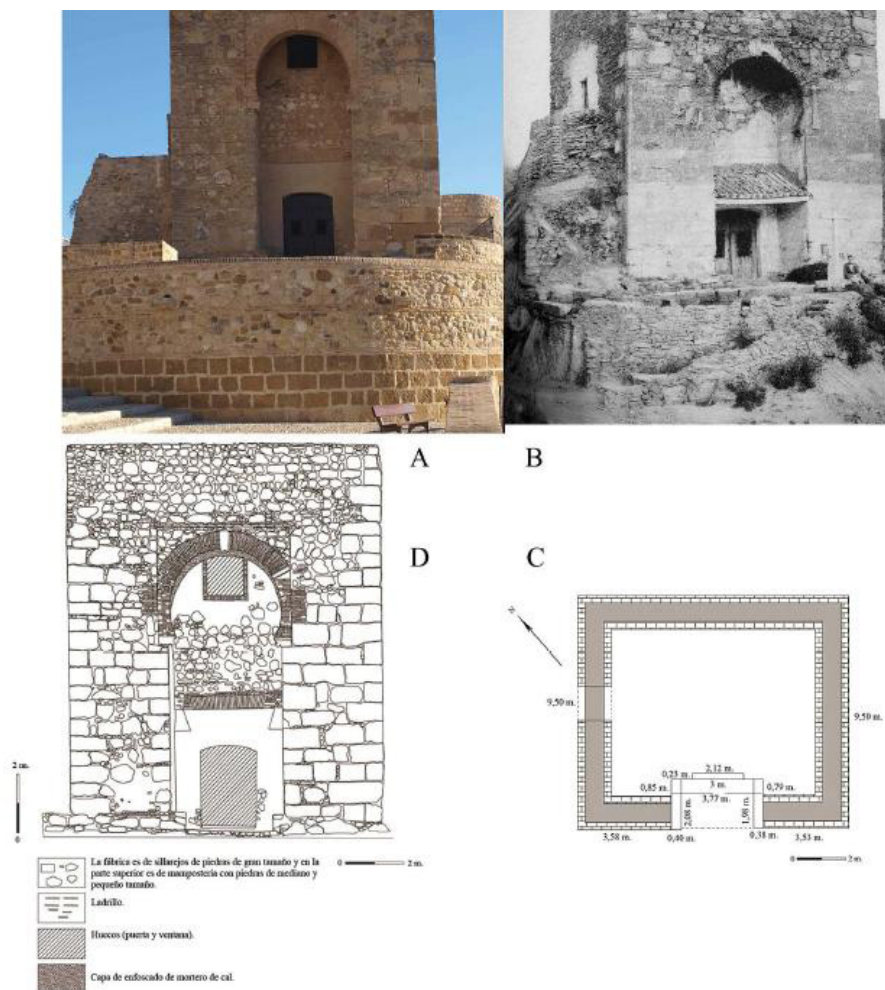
Puerta de Málaga. A) Vista actual en el frente S-O. B) Estado de la puerta en 1915 (Fuente: San Millán. 2001: P. 14). C) Planta simple. D) Frente S-O. Técnica constructiva: sillarejo y mampostería.
